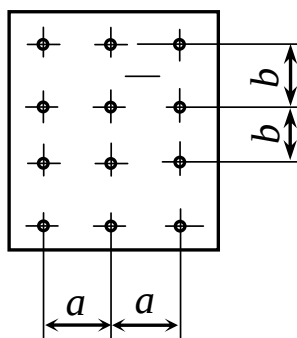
Разбивка круглых отверстий на водосборном трубопроводе
